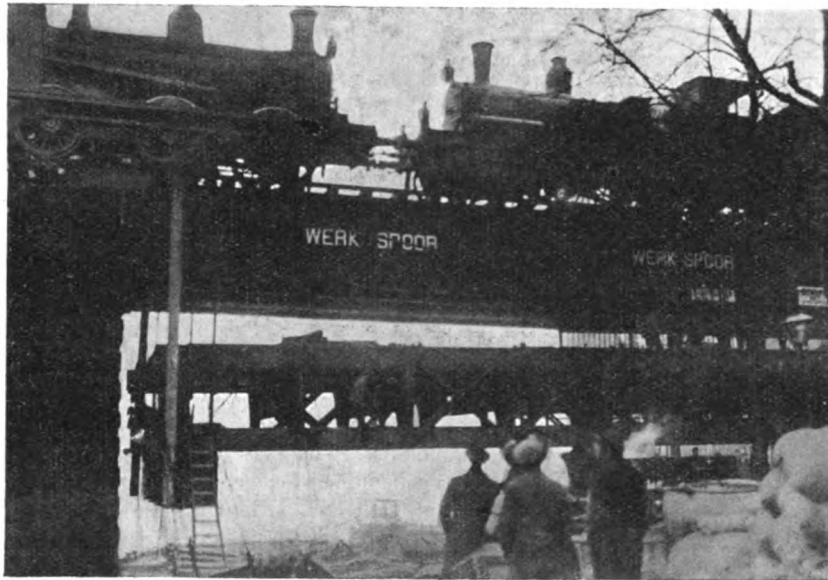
Alte Brücke mit abgeschnittenen Enden.
